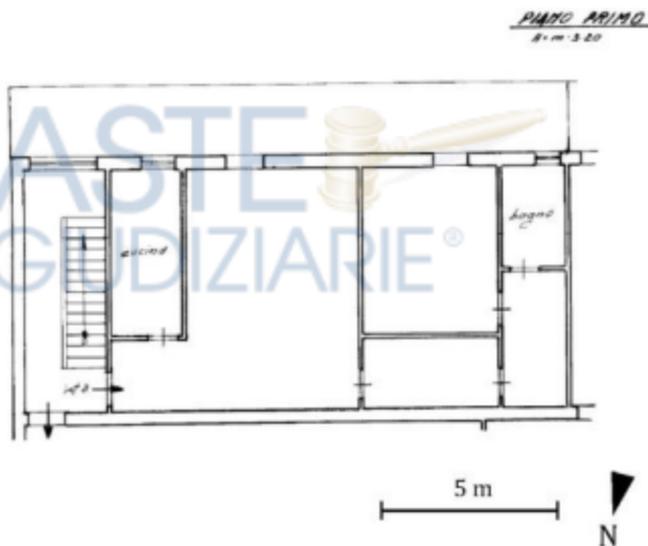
Estratto Planimetria Catastale - Civile abitazione Foglio 43, Part. 1210, Sub 7
